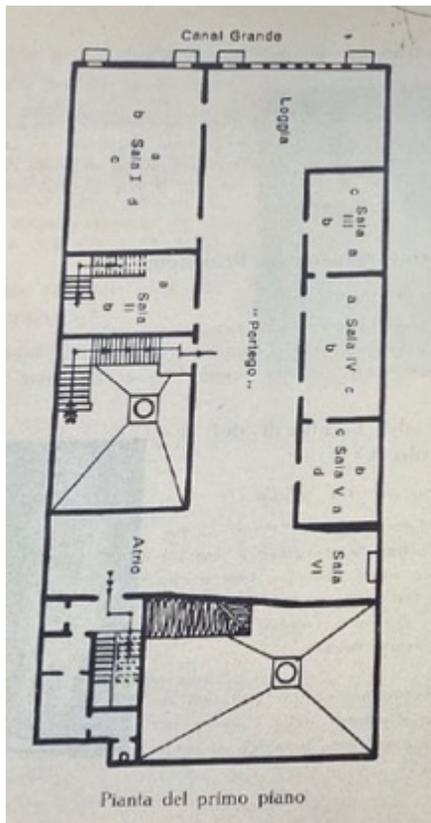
Pianta del primo piano dopo il restauro di Giorgio Franchetti.
